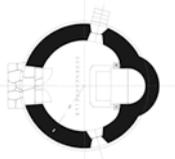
Grundriss BDA Wien. M 1:400.
